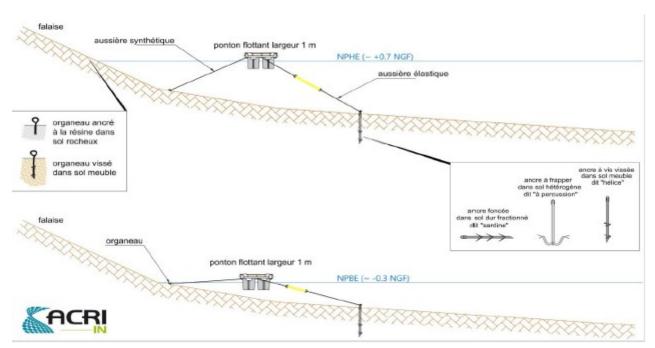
Plan de coupe d'ancrage des pontons flottants de la ZMEL (source : p.45 de la pièce 2)
